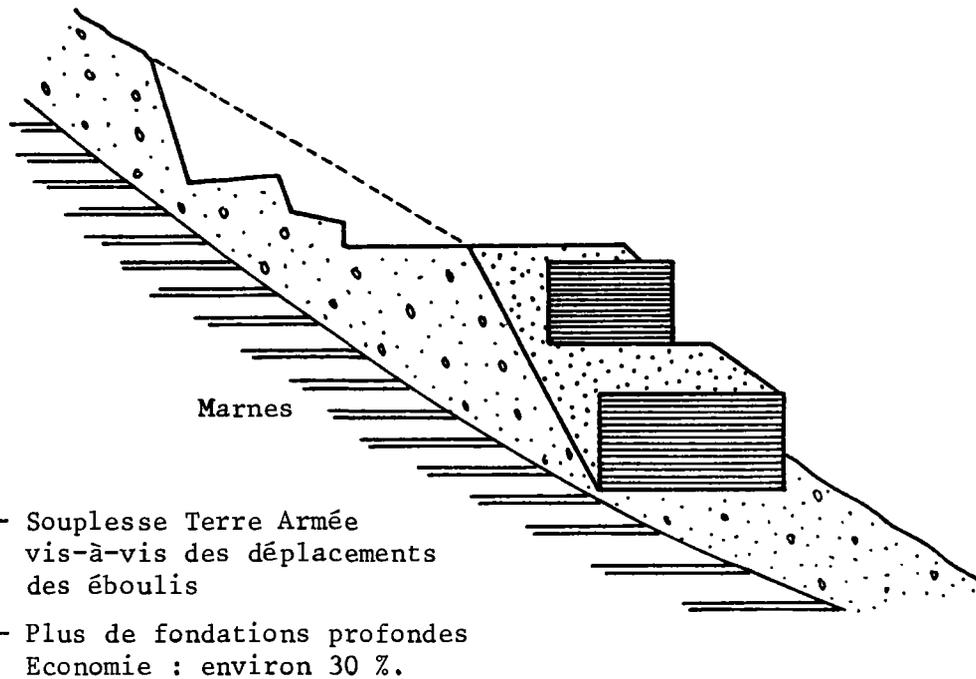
Comparaison de soutènements sur éboulis de pente : mur de soutènement sur pieux et mur en terre armée.
